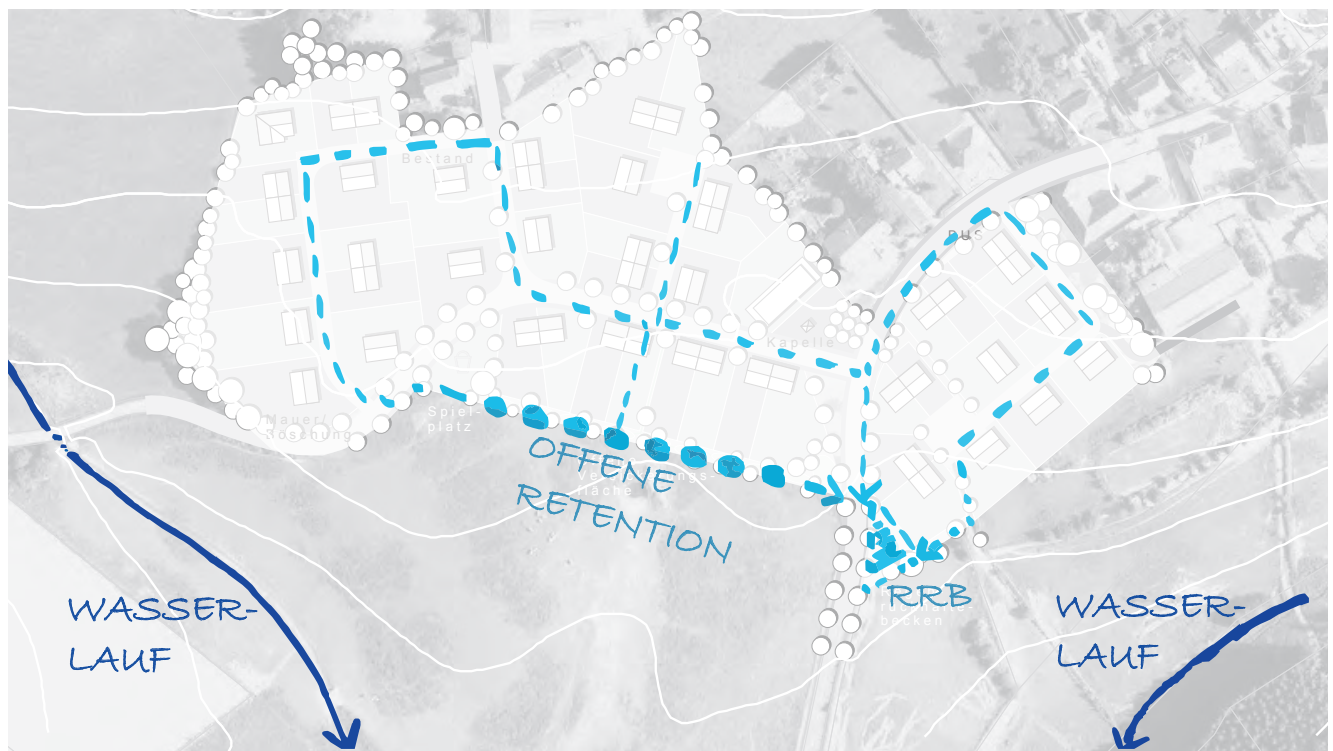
Skizzierung der Regenwasserführung zu den Standorten der Rückhaltebecken
